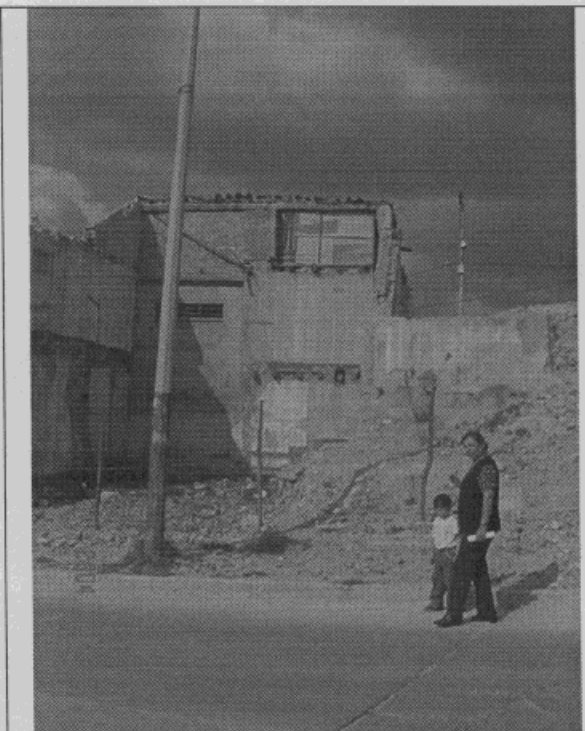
Vista posterior de la vivienda inspeccionada. Parte del muro fue reconstruido; el muro del costado sur oriental (derecha) presenta pérdida de verticalidad.
